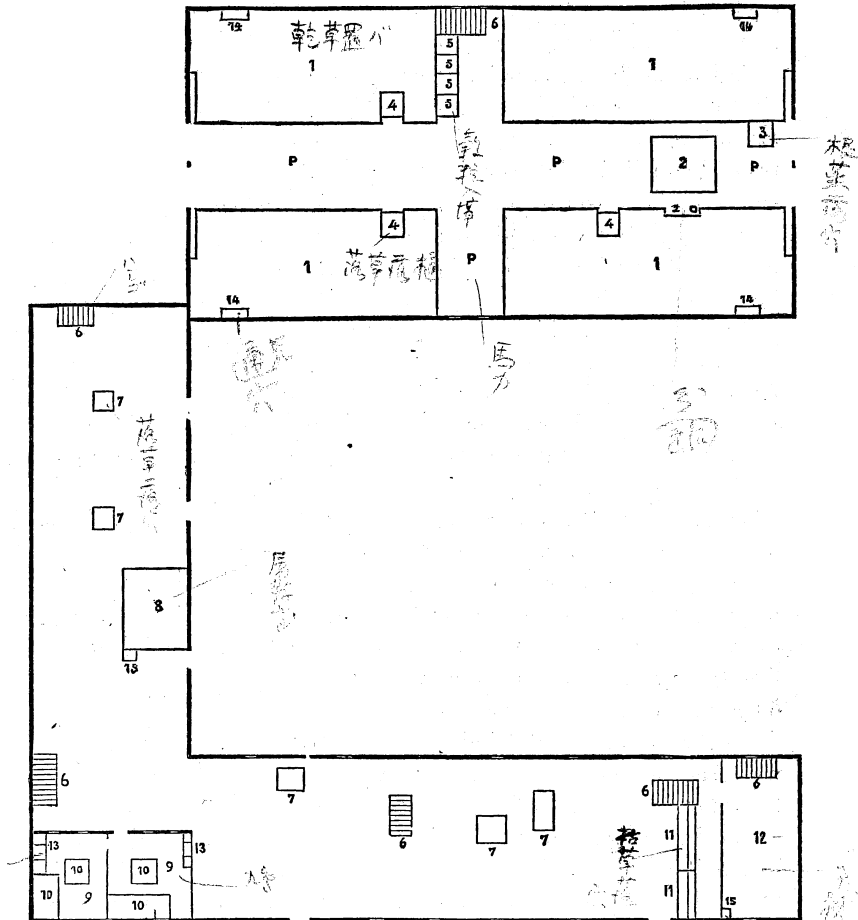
1871年のマサチューセッツ農科大学バーン1階平面図
